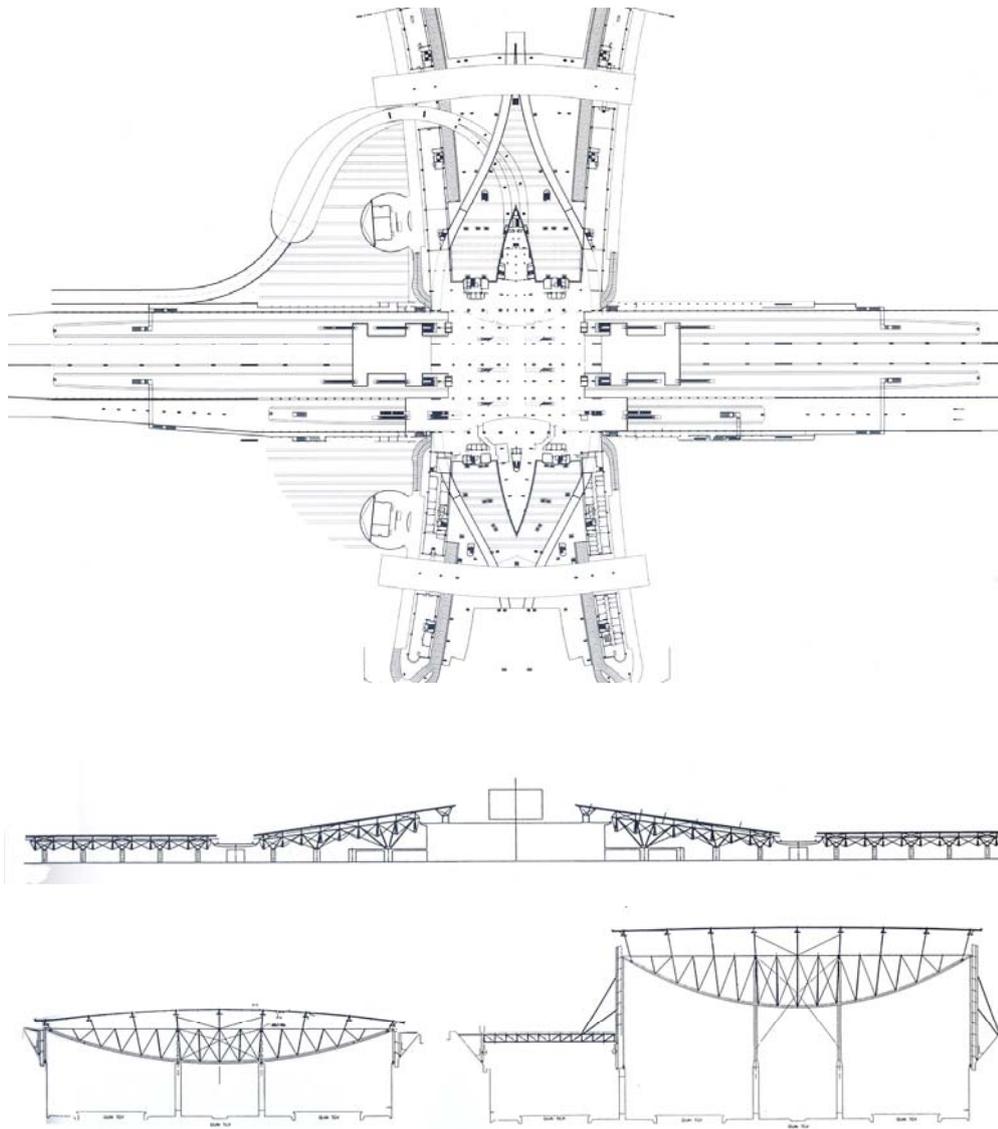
, 887 et 888 Plan du niveau de la plate-forme, coupes longitudinale et transversale de Roissy
